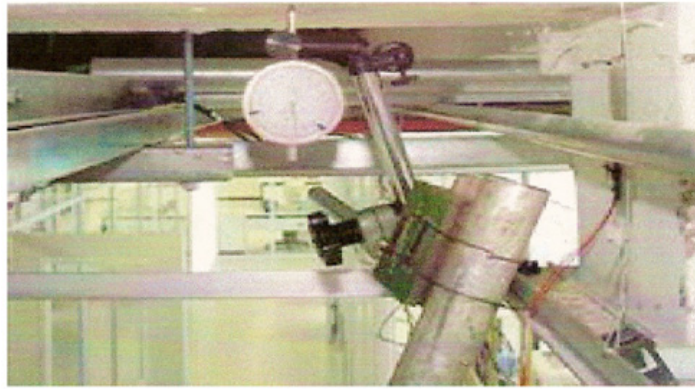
Instrumentação do pilar (recalque da fundação)
